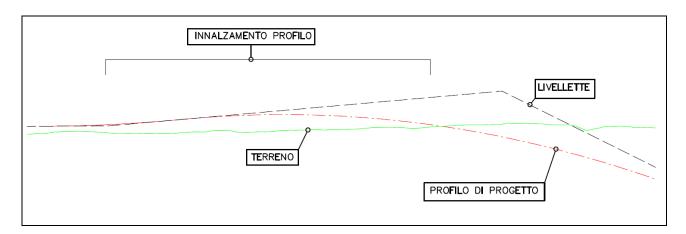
ESEMPIO DI INNALZAMENTO DEL PROFILO DI PROGETTO IN CORRISPONDENZA DELLE RAMPE DI ACCESSO AL SOTTOVIA
